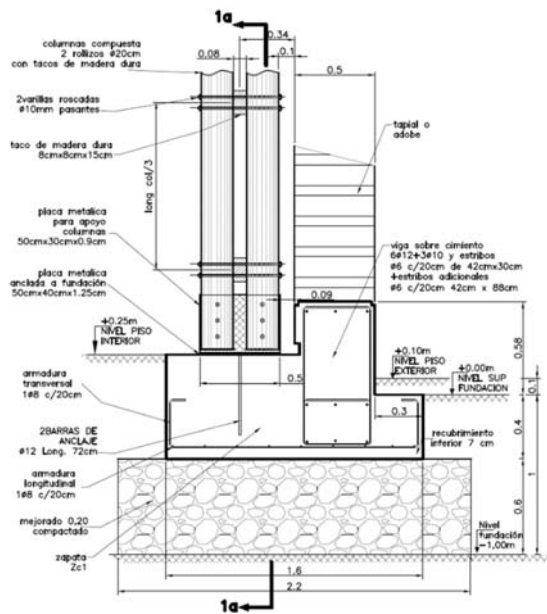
FUNDACION TIPO COLUMNAS DE MADERA
